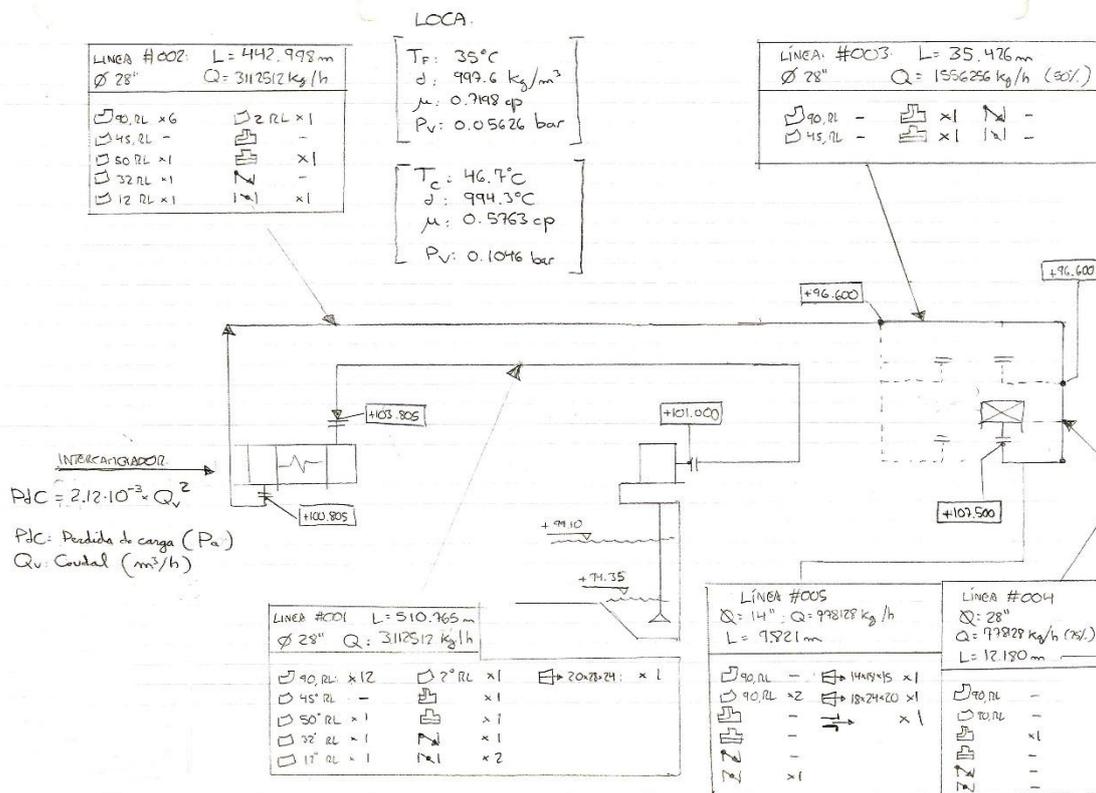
Croquis simplificado distribución de las tuberías
